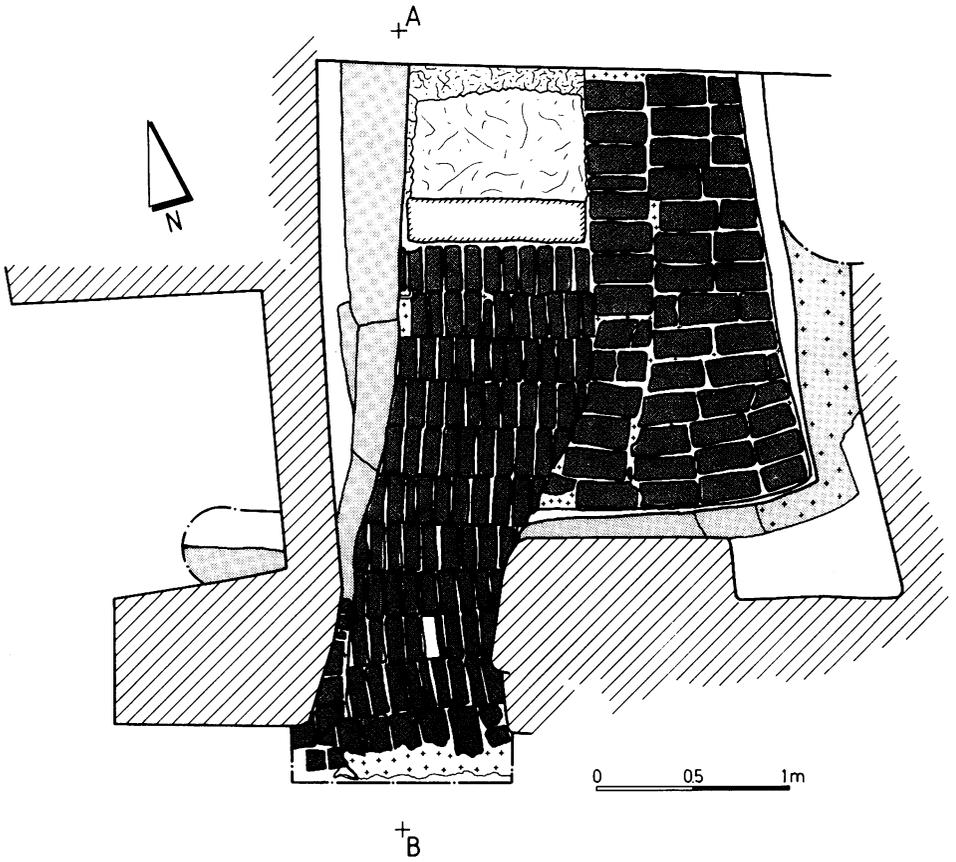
Grundriß der Mikveh. Umfassungsmauern schraffiert. Dunkel gerastert die Ziegelkonstruktion, weiß das Felsenbecken und Hausteinteile
